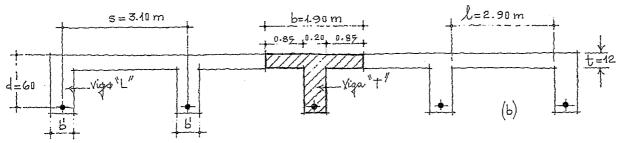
Corte de la estruc Tura, (b). Cólculo del ancho efectivo del potín:
